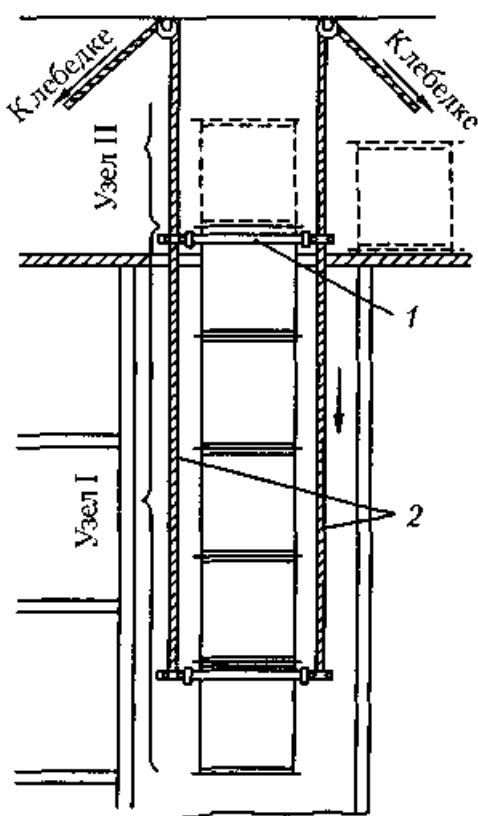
Последовательность монтажа вертикальных воздухопроводов с помощью специальных захватов методом наращивания сверху:
